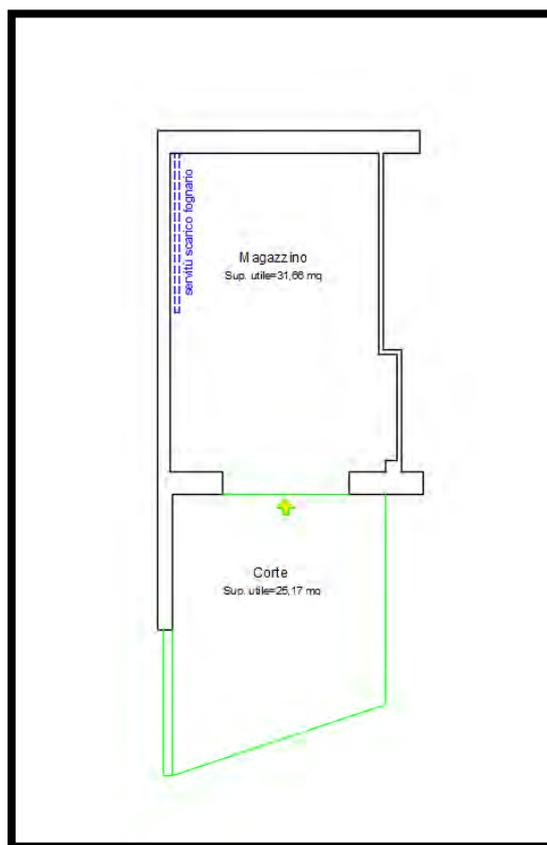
Rilievo appartamento part. 683 sub 5 – Piano seminterrato
